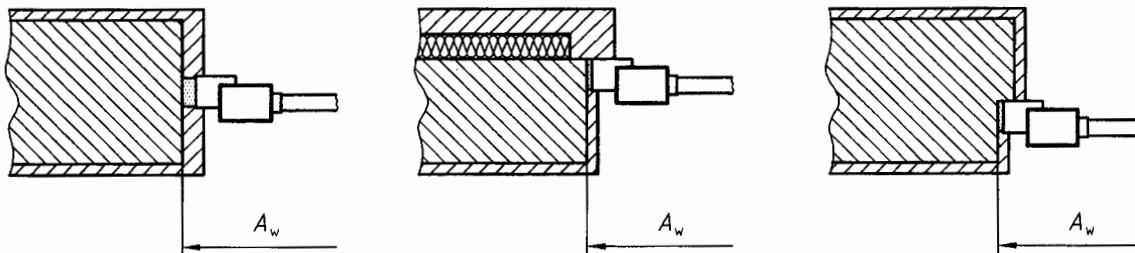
Ermittlung des lichten Rohbaumaßes bei Fensteröffnungen (stumpfer Anschlag, zweischaliges Mauerwerk, mit Innenanschlag) A_w = Fensterfläche (Index w – window, Fenster)
